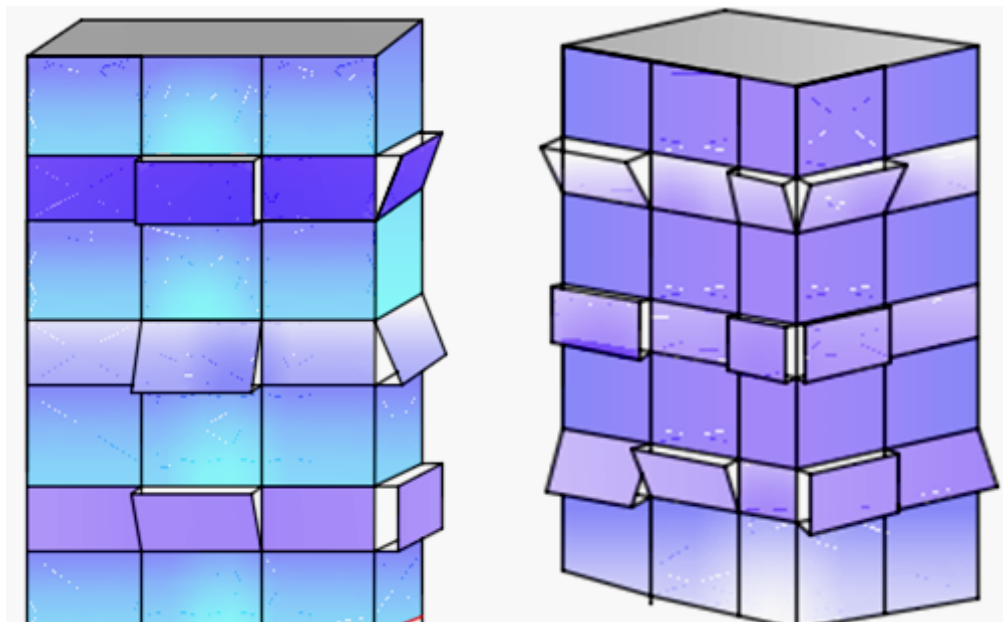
Схемы фасадов с динамичными межэтажными светопрозрачными фасадными панелями
